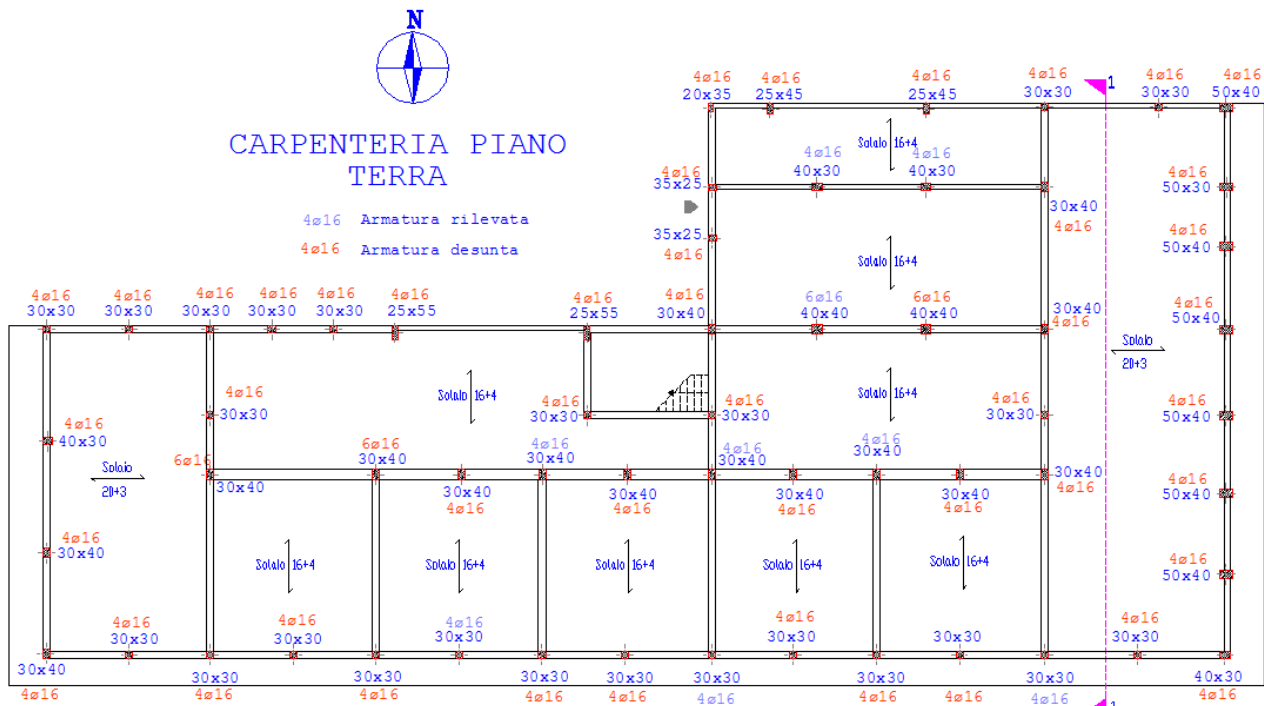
Armatura rilevata e presunta – carpenteria piano terra (LC1)
